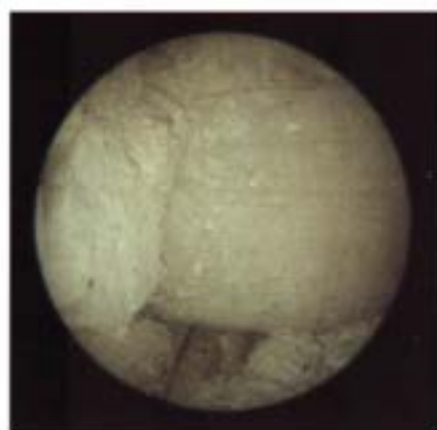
Observação boroscópica da entrega de uma das vigas do pavimento
